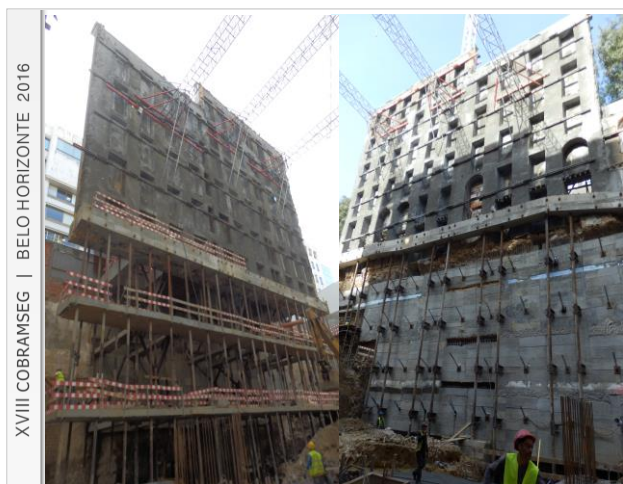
Vista das fachadas preservadas e da parede de contenção por baixo do recalçamento.
